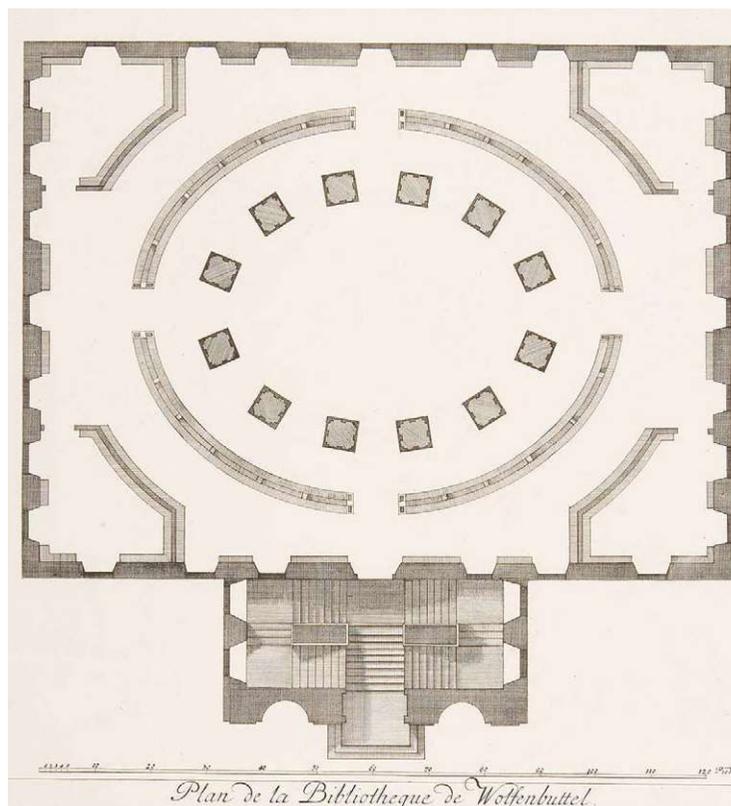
Hofbibliothek Wolfenbüttel, Grundriss
